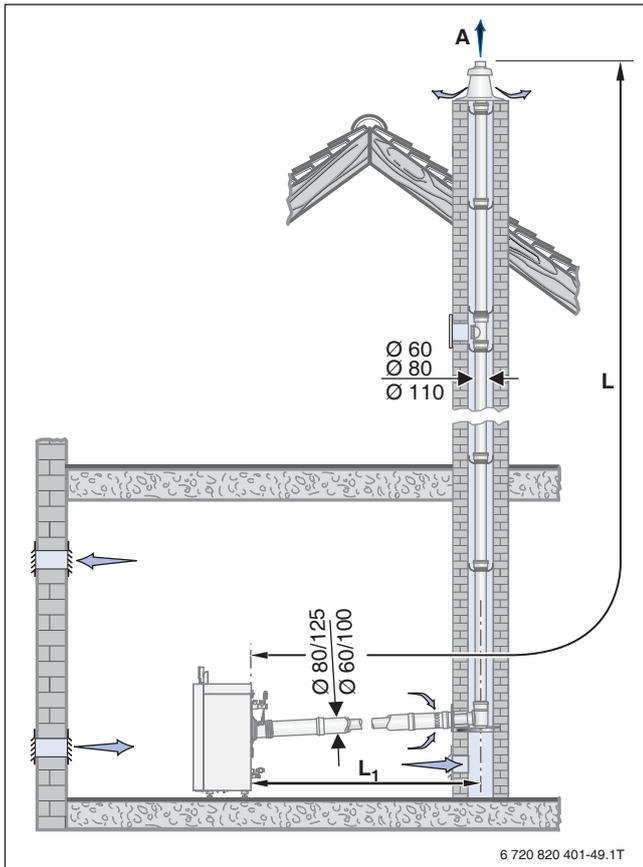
Montagevariante mit dem Bausatz GA-X + GA-K
